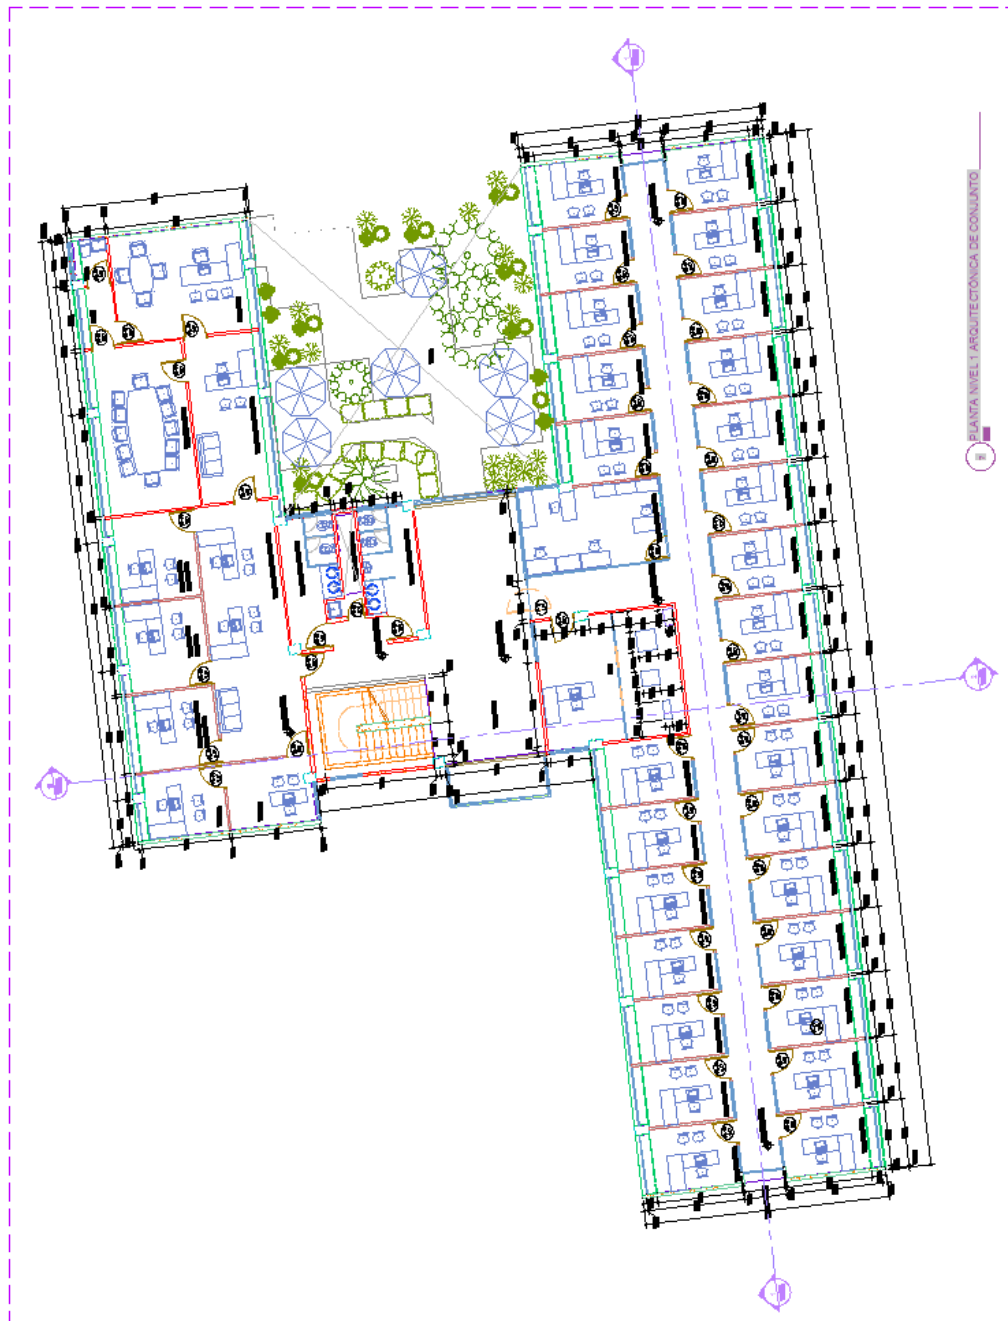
Planta de conjunto de la vista del Nivel 1 ya remodelado.
